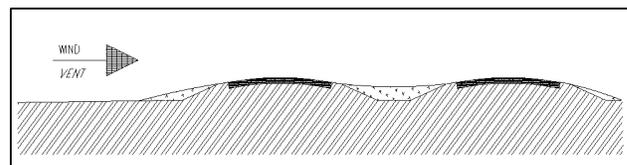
Des chaussées de même élévation réduisent l'accumulation de neige sur la route.
